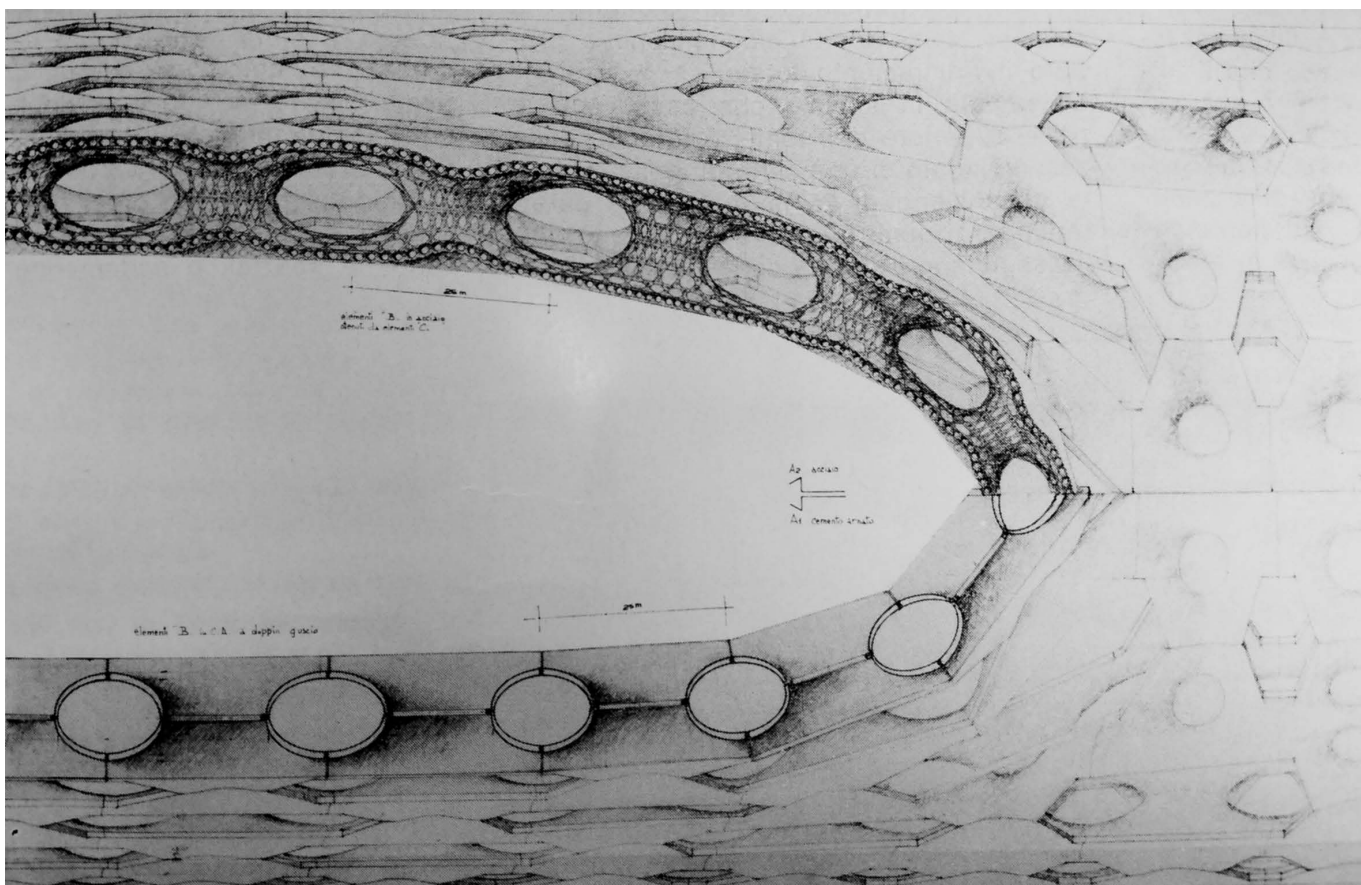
R. Semino, sezione longitudinale della piastra galleggiante sullo Stretto di Messina, dettaglio, 1969 (per gentile concessione dell'arch. Rinaldo Semino).
